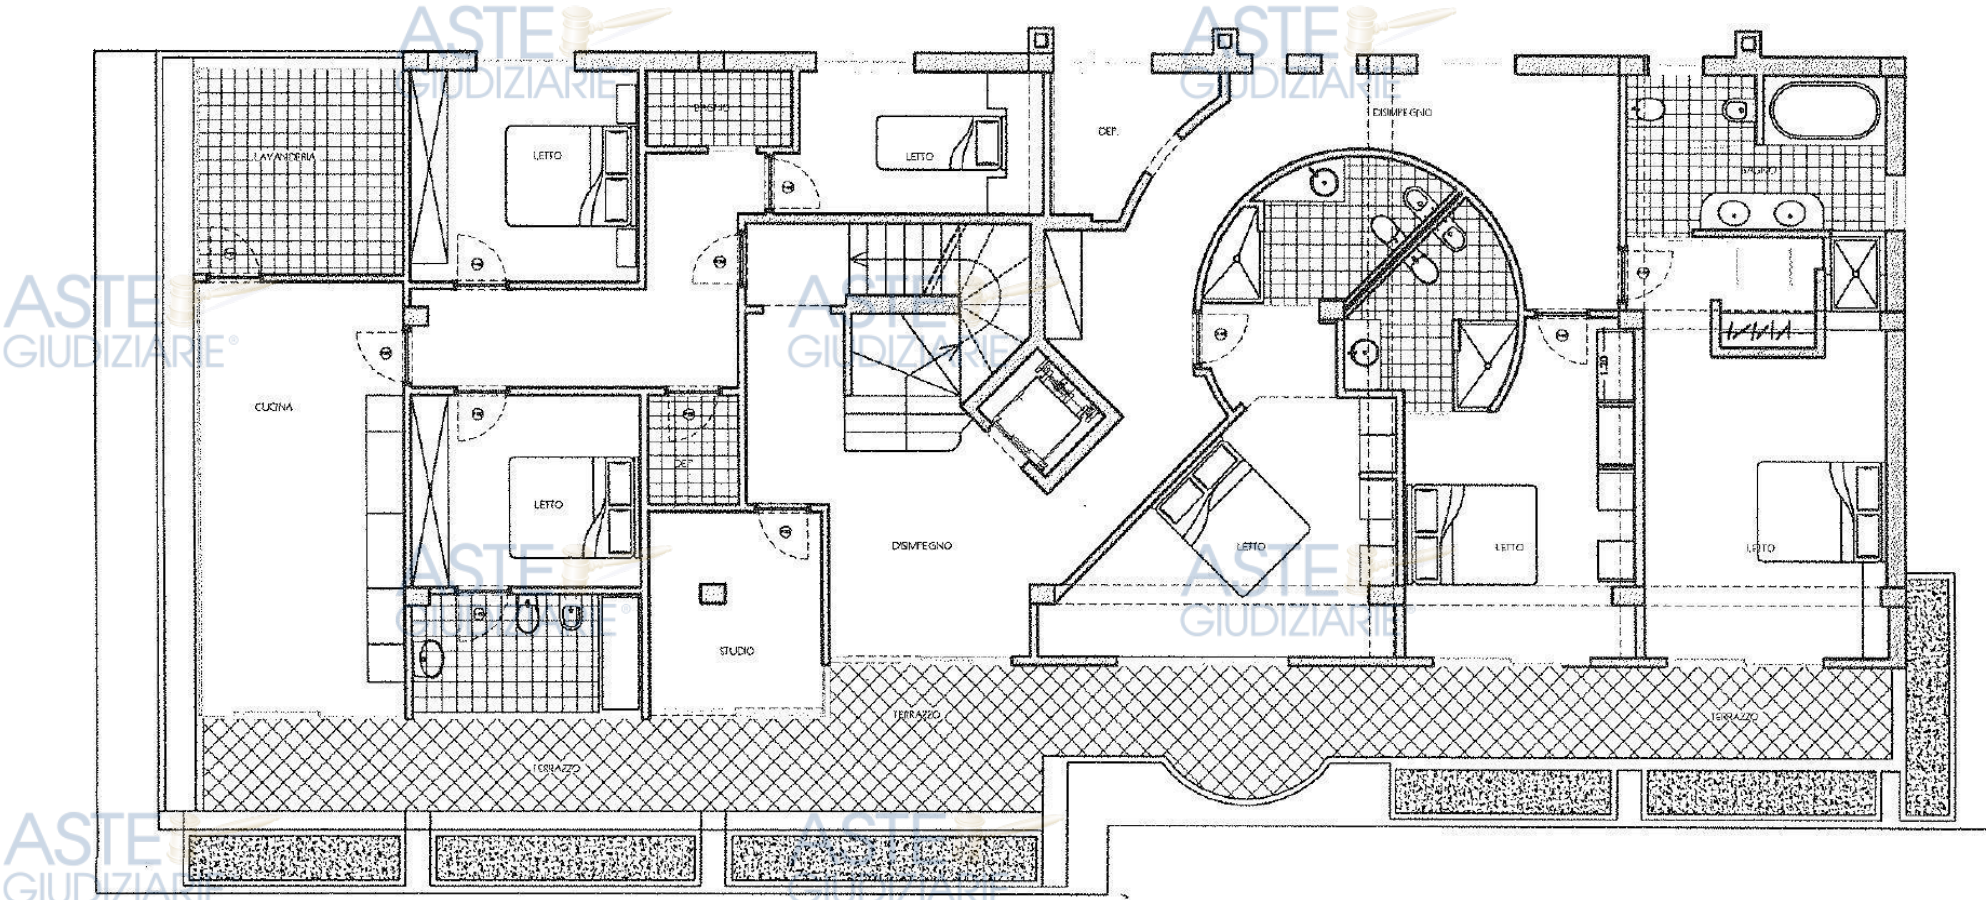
Stralcio pianta piano secondo – Grafici di D.I.A. prot. 10231 del 18/01/2007
